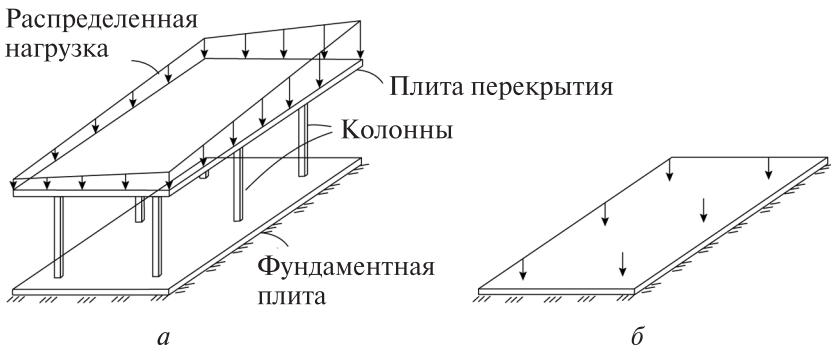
Нагрузки, действующие на фрагмент строительной конструкции, включающей фундаментную плиту, колонны и плиту перекрытия:
